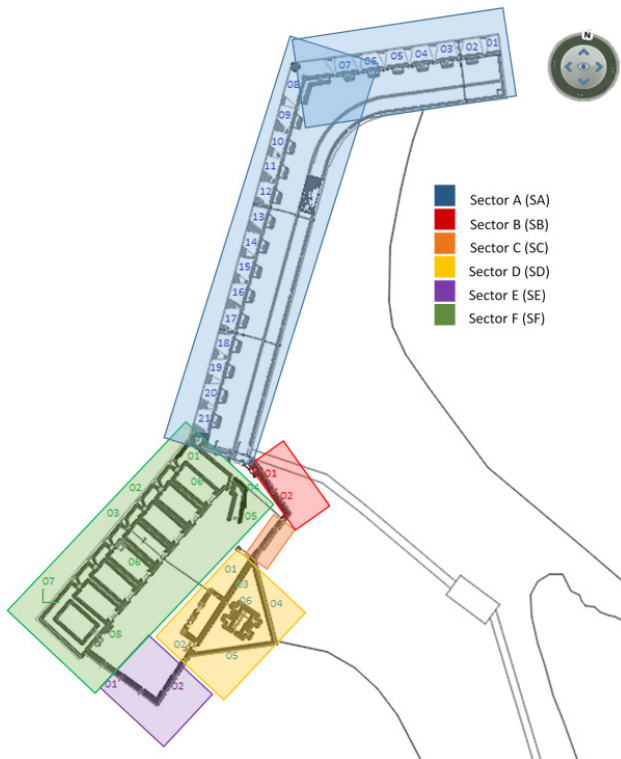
Estructura Fuerte Batería de San José, vista en planta y división por sectores.
